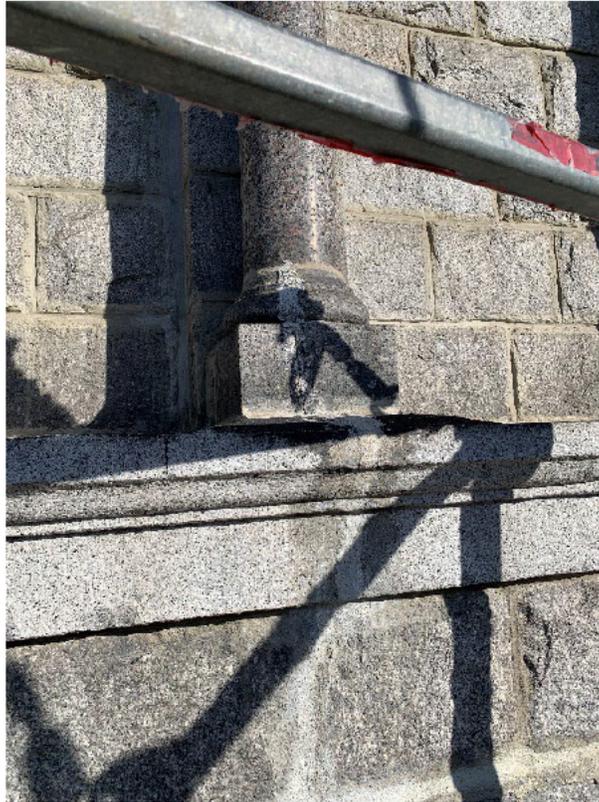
Fissuration de la base d'une colonne et du parement
